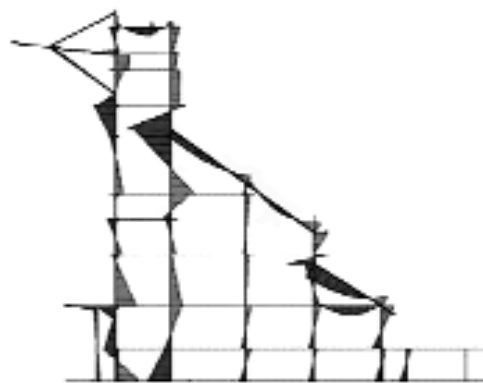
Эпюры изгибающих моментов в балках и колоннах от расчетной вертикальной нагрузки
